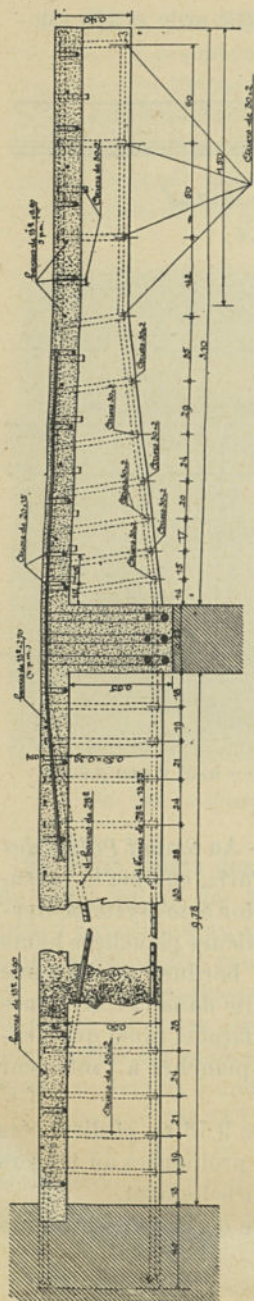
Grand Palais des Beaux-Arts. Plancher haut d'une salle du rez-de-chaussée.
